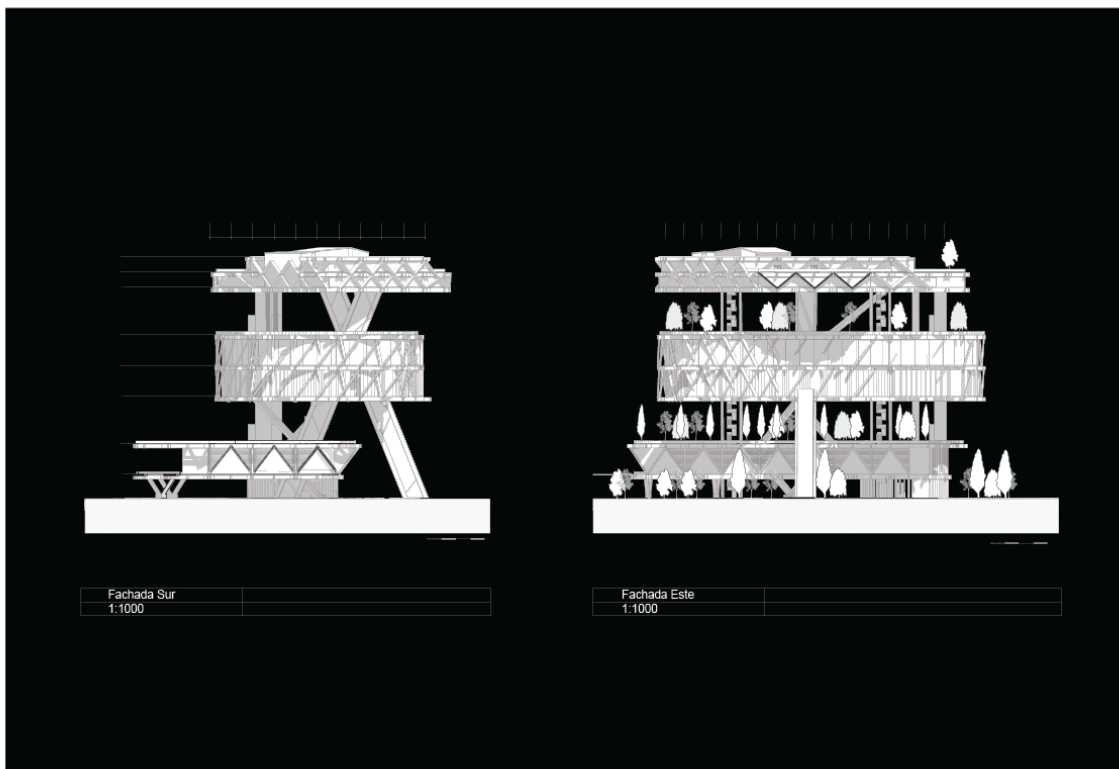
Fachadas Sur & Este, elaboración propia 2022
